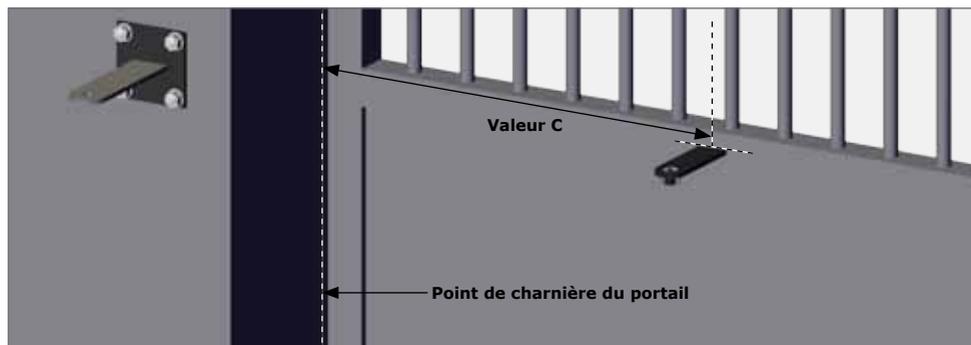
FIXATION DU SUPPORT DE PORTAIL SUR UN PORTAIL EN ACIER
